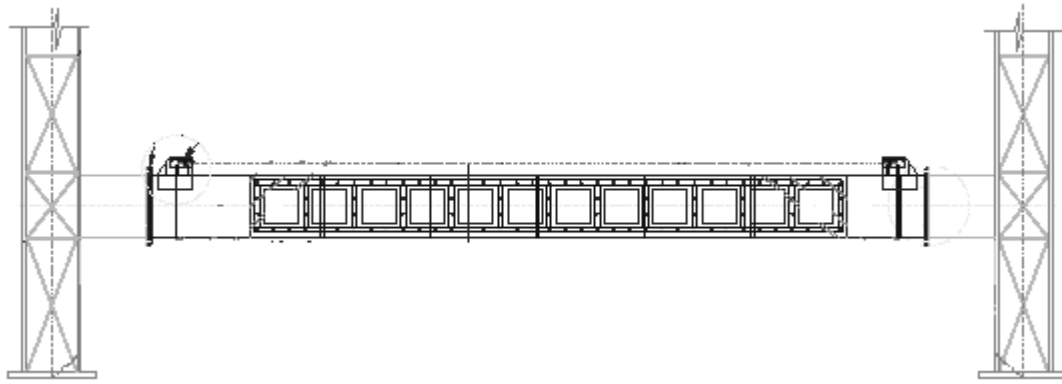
Instalación de bancada y bastidor en viga cajón.
